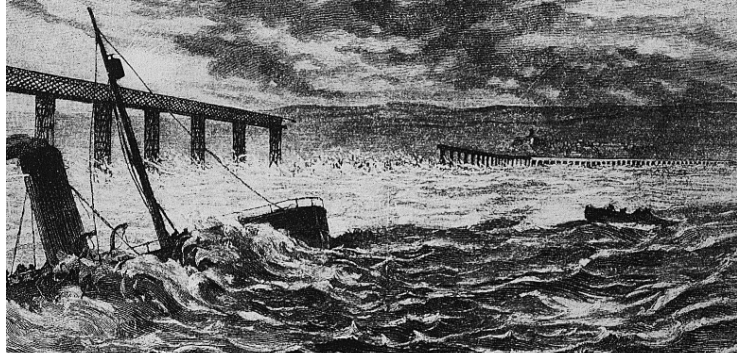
Tay Bridge, Schottland, nach dem Einsturz, 28.12.1879
